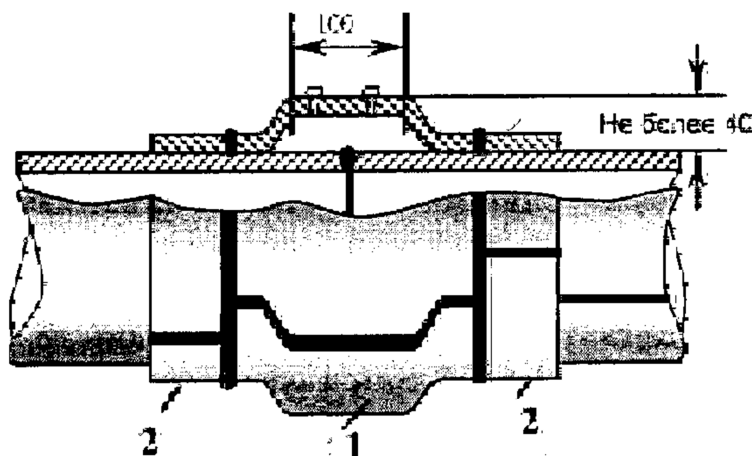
Муфта галтельная для ремонта сварных кольцевых швов (тип ПЗ)
